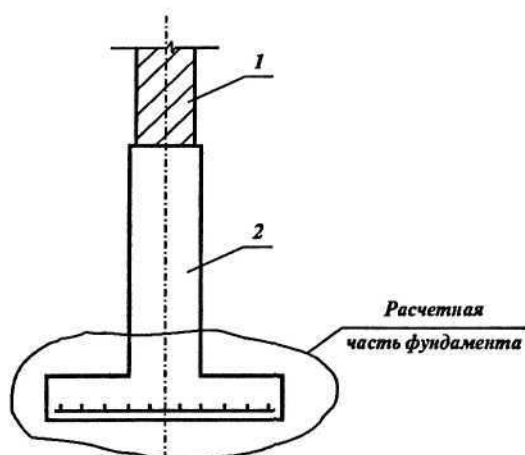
Сечение ленточного фундамента при уширенном нижнем уступе:
